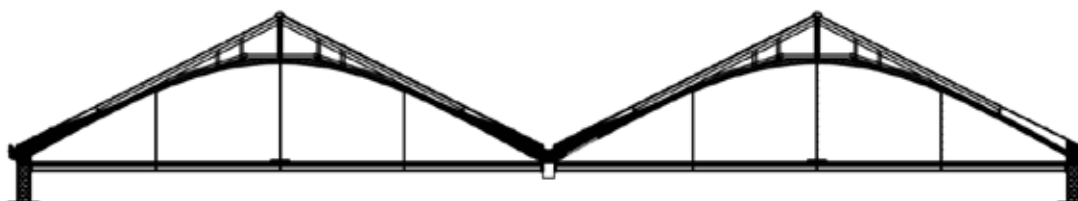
Sezione verticale trasversale con l'inserimento delle reticolari metalliche interne.
